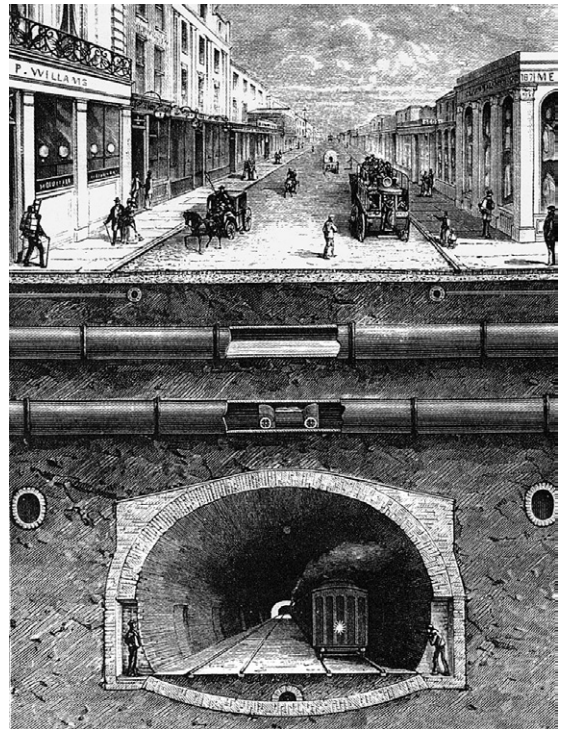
Querschnitt durch eine Londoner Straße, 1875
